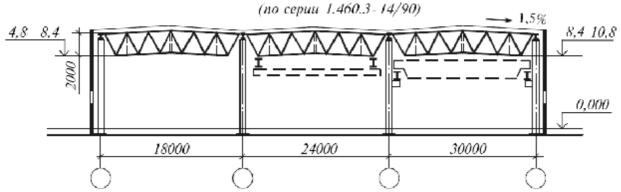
Каркас здания из конструкций типа "Молодечно" Здания из конструкций типа "Канск" (рис. 4). Представляет одноэтажное производственное здание с применением несущих одно- и многопролетных рам из прокатных широкополочных и сварных двутавровых балок с шагом 12 м и 6м.
